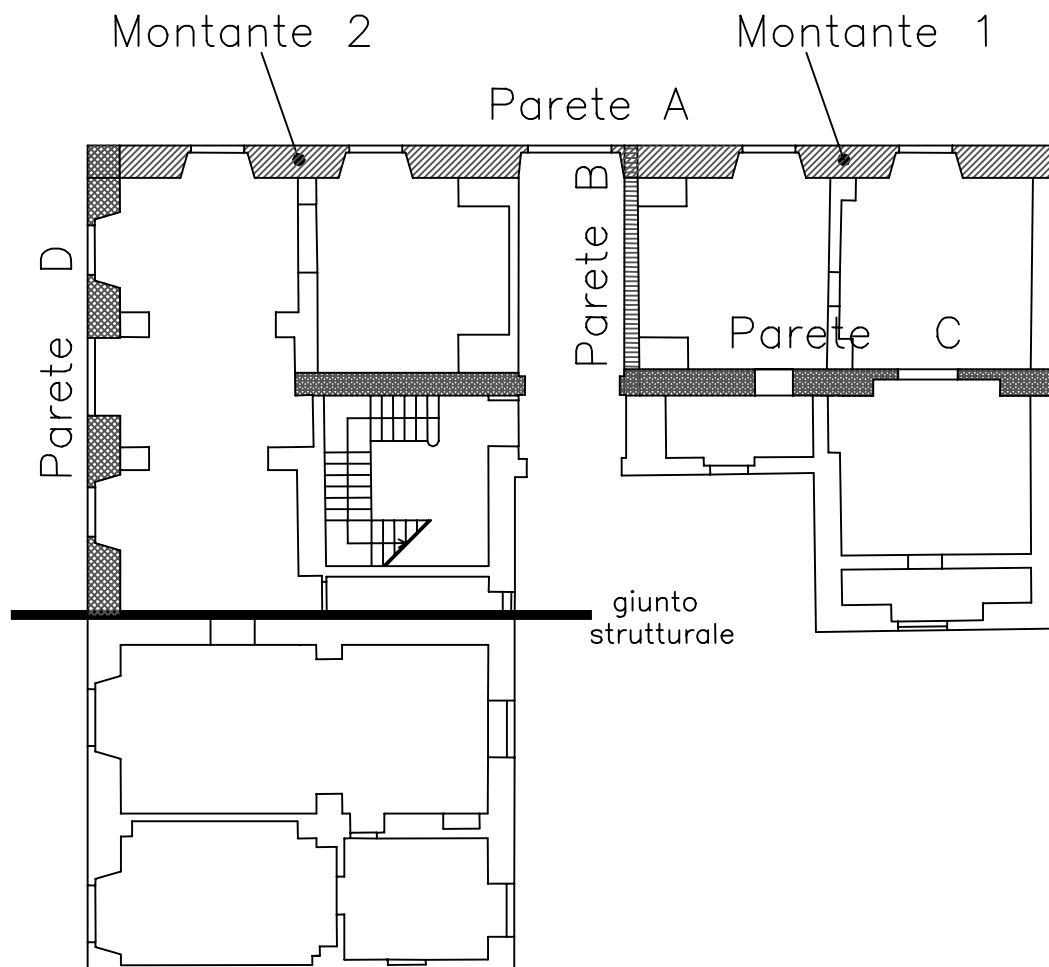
Pianta del palazzo con indicazione degli elementi strutturali analizzati.
